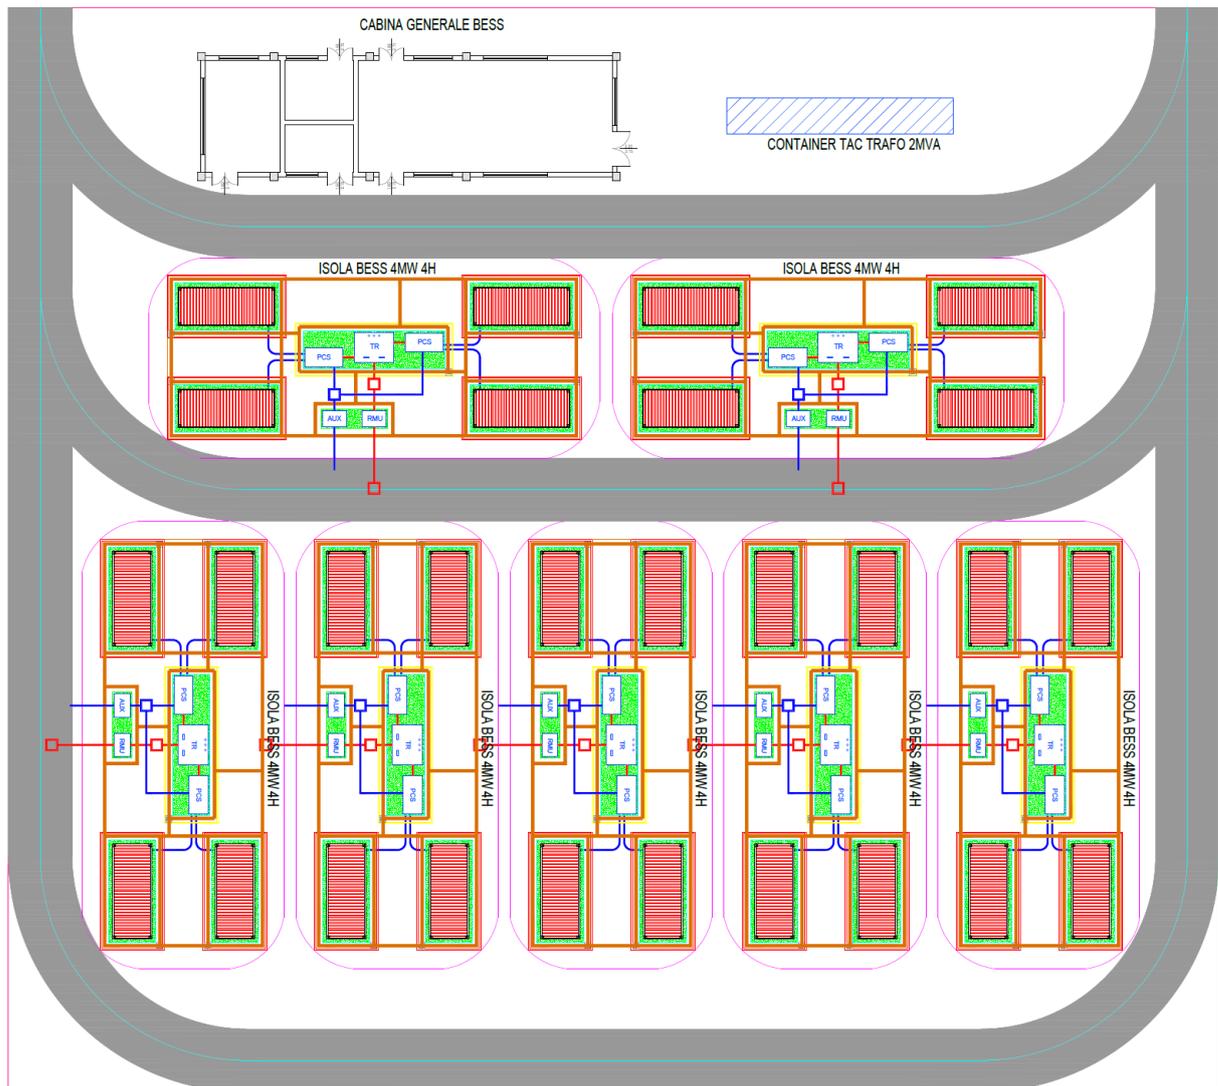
Layout del Sistema BESS 25 MW – 4h
